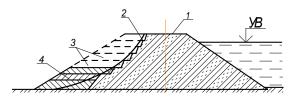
Схема отсыпки грунта горизонтальными слоями: I – гребень дамбы; 2 – уступы на сохранившейся части насыпи; 3, 4 – проектные и уложенные слои грунта
